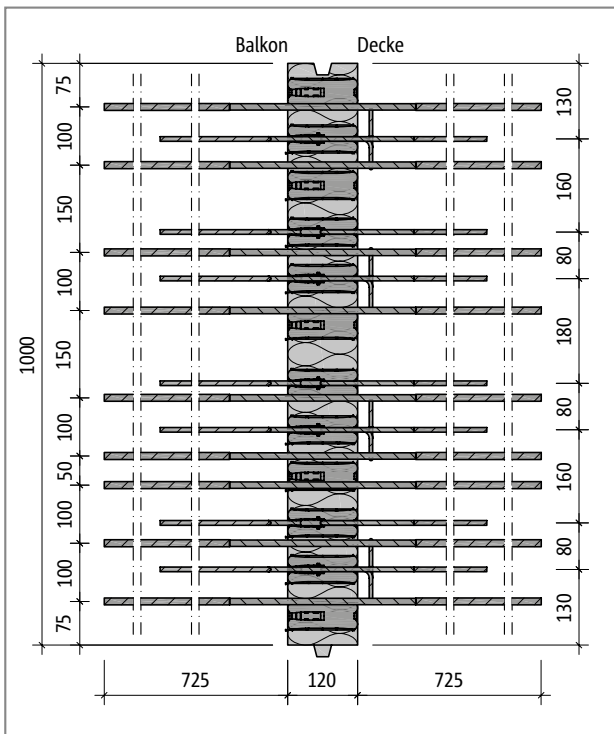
Schöck Isokorb® XT Typ K-M8: Produktgrundriss
